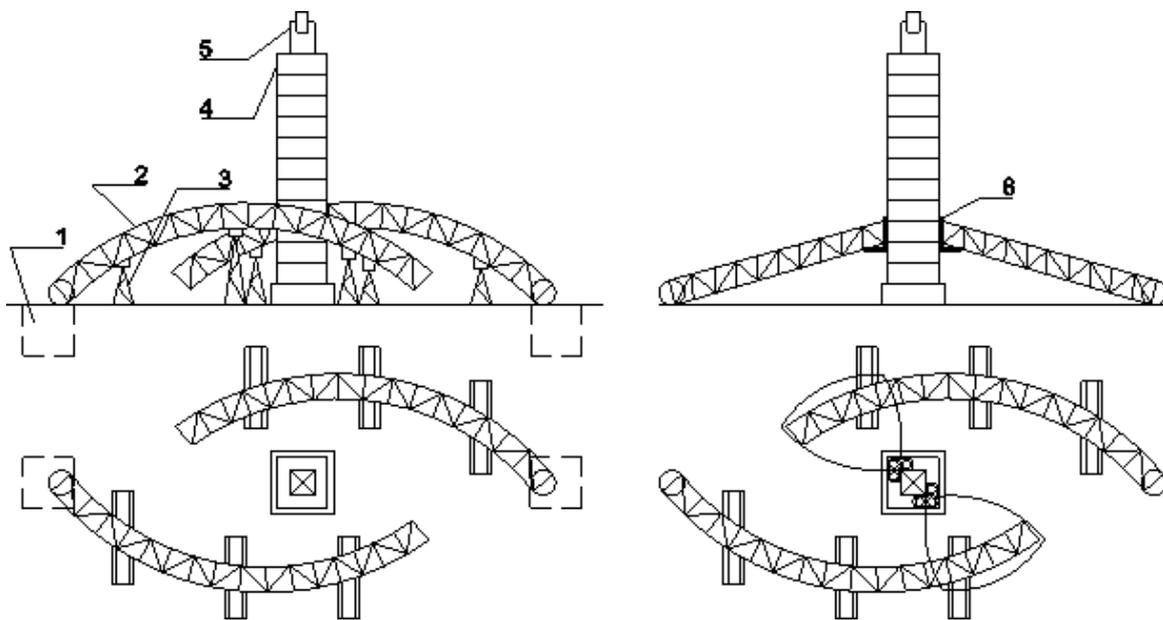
Схемы укрупнительной сборки и монтажа полуарок с помощью гидродомкратов:
